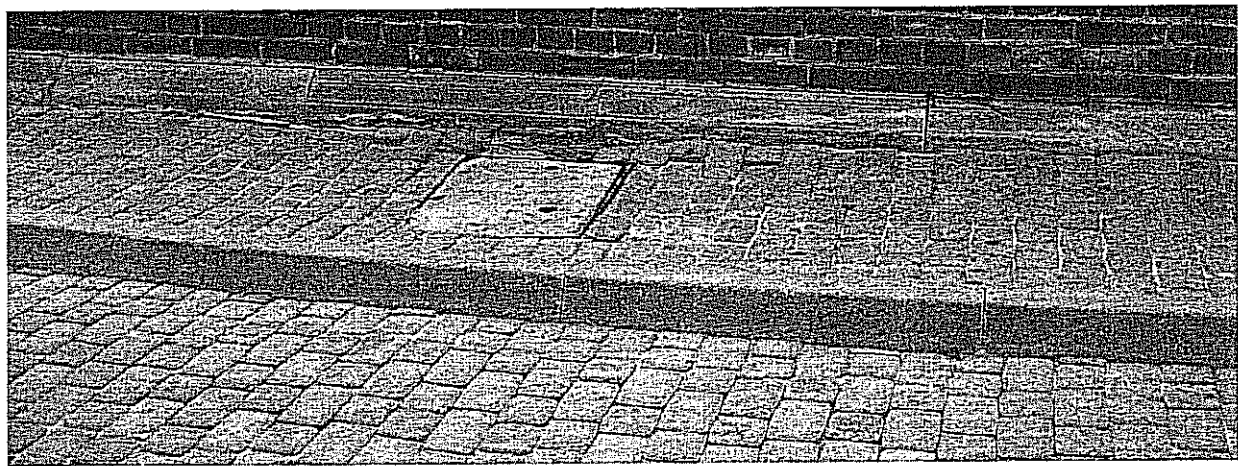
Zapadanie się i wypiętrzanie elementów nawierzchni w pobliżu studzienek telekomunikacyjnych
